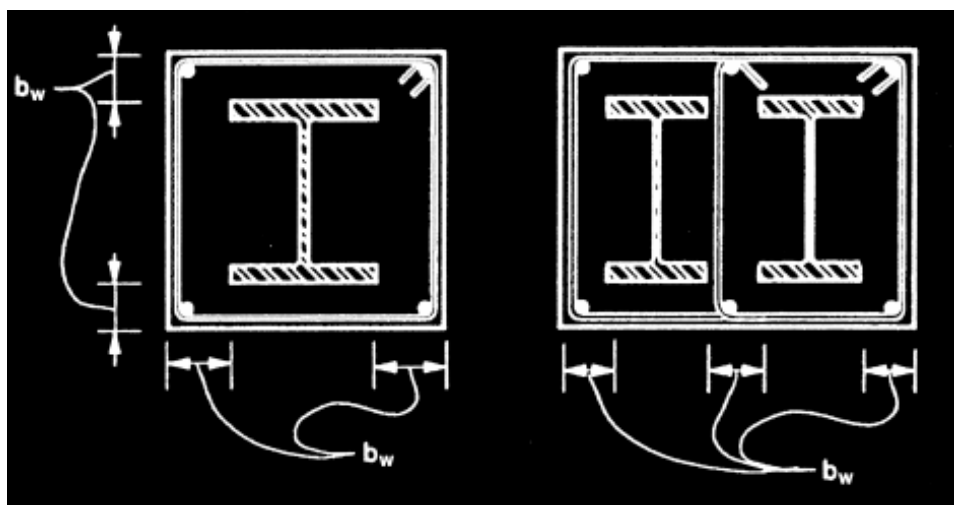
Ancho efectivo para calcular la resistencia al corte de una columna SRC [1]
